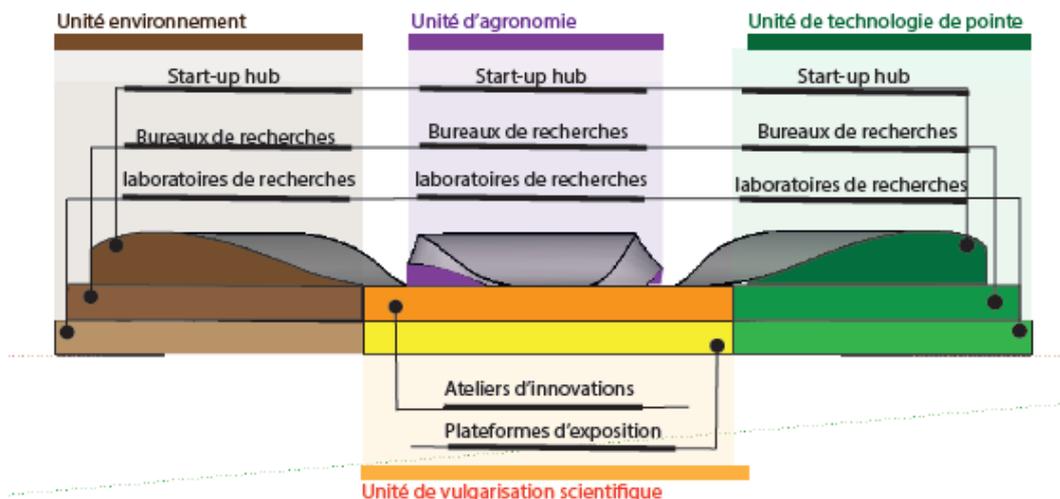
schéma de structuration verticale selon la coupe AA de la fig 84
